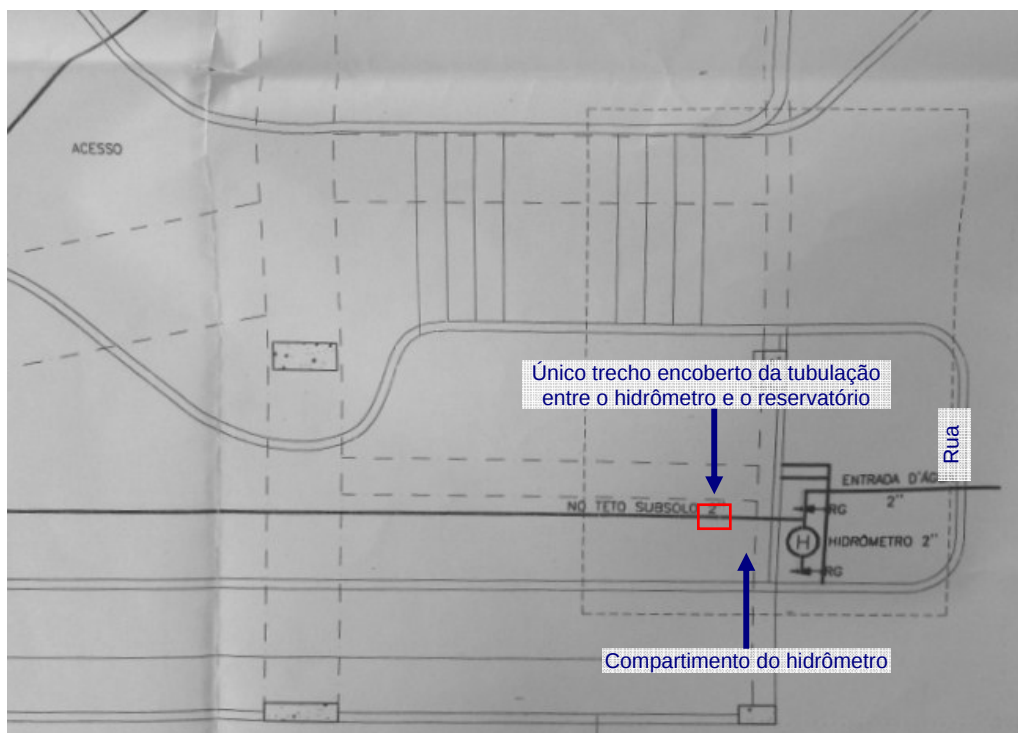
Trecho da planta baixa do pavimento de acesso, com compartimento do hidrômetro.
